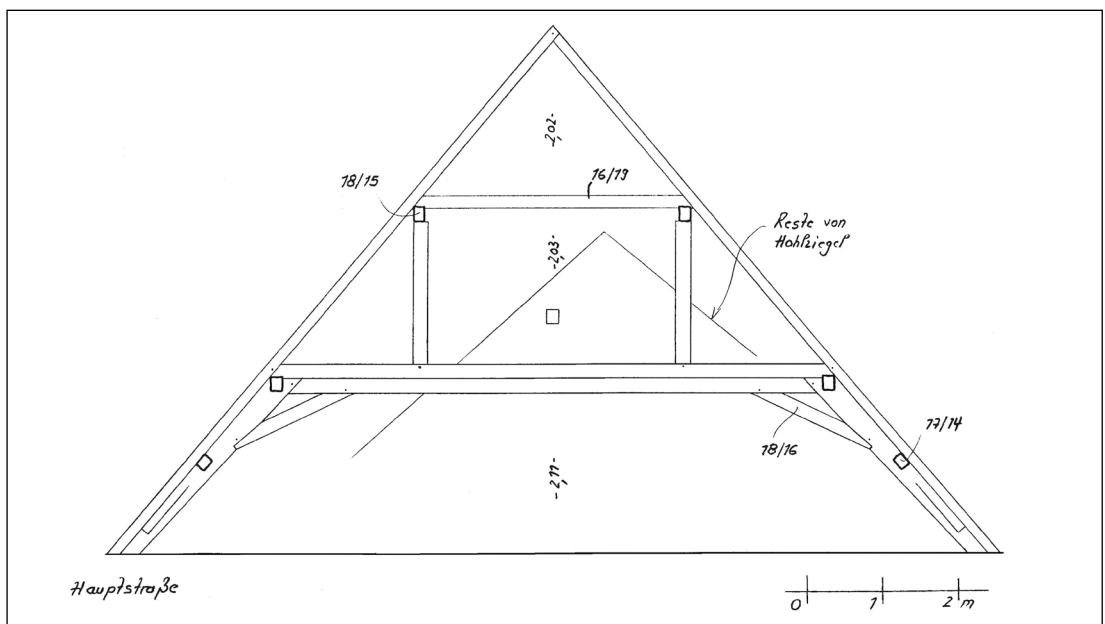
Hauptstraße 44, Querschnitt Dachwerk.
